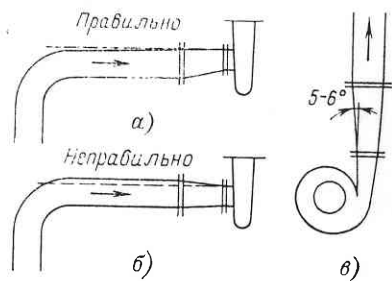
Прокладка всасывающего трубопровода и присоединение к насосу напорного трубопровода
